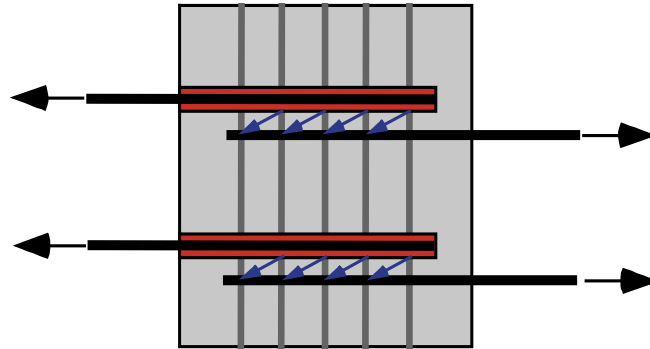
Nachträglicher Bewehrungsanschluss mit Lastweiterleitung über bestehende Bewehrung
